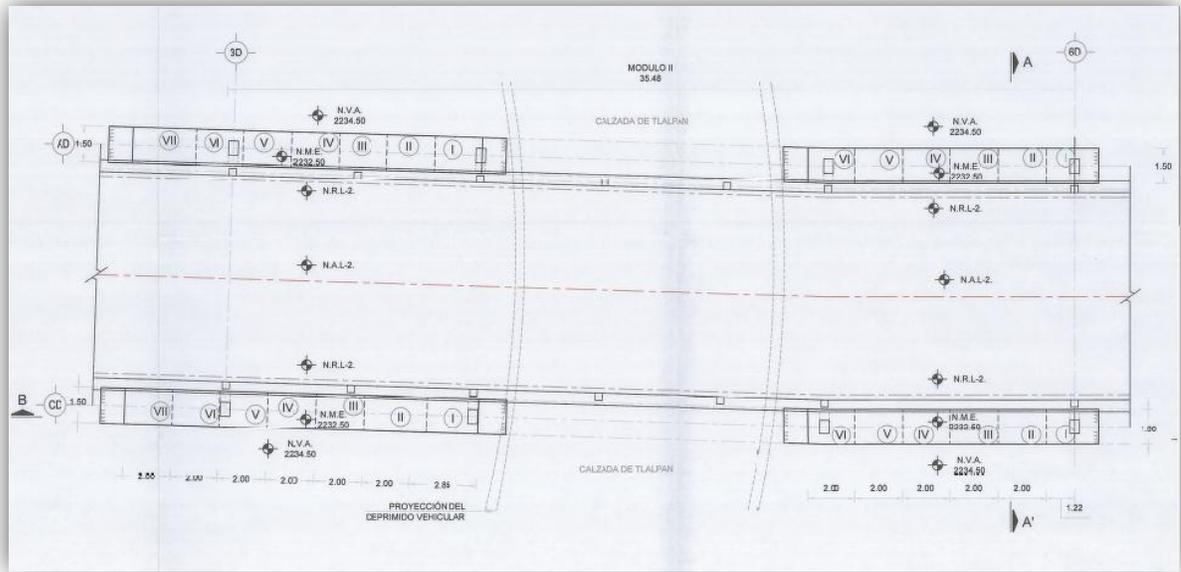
Planta de Secuencia de Excavación Tipo Módulo II y III
